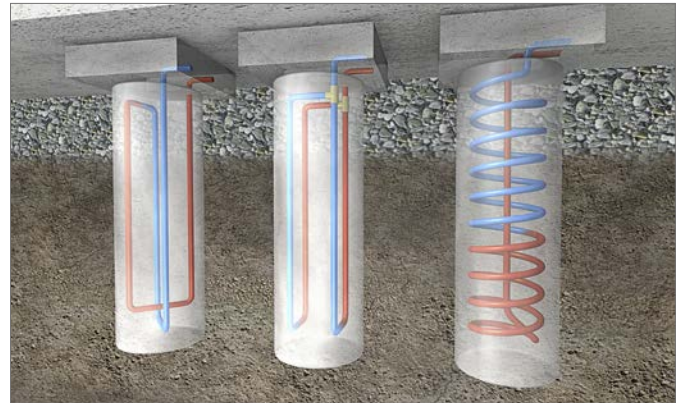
Kollektorrohre im Bewehrungskorb
